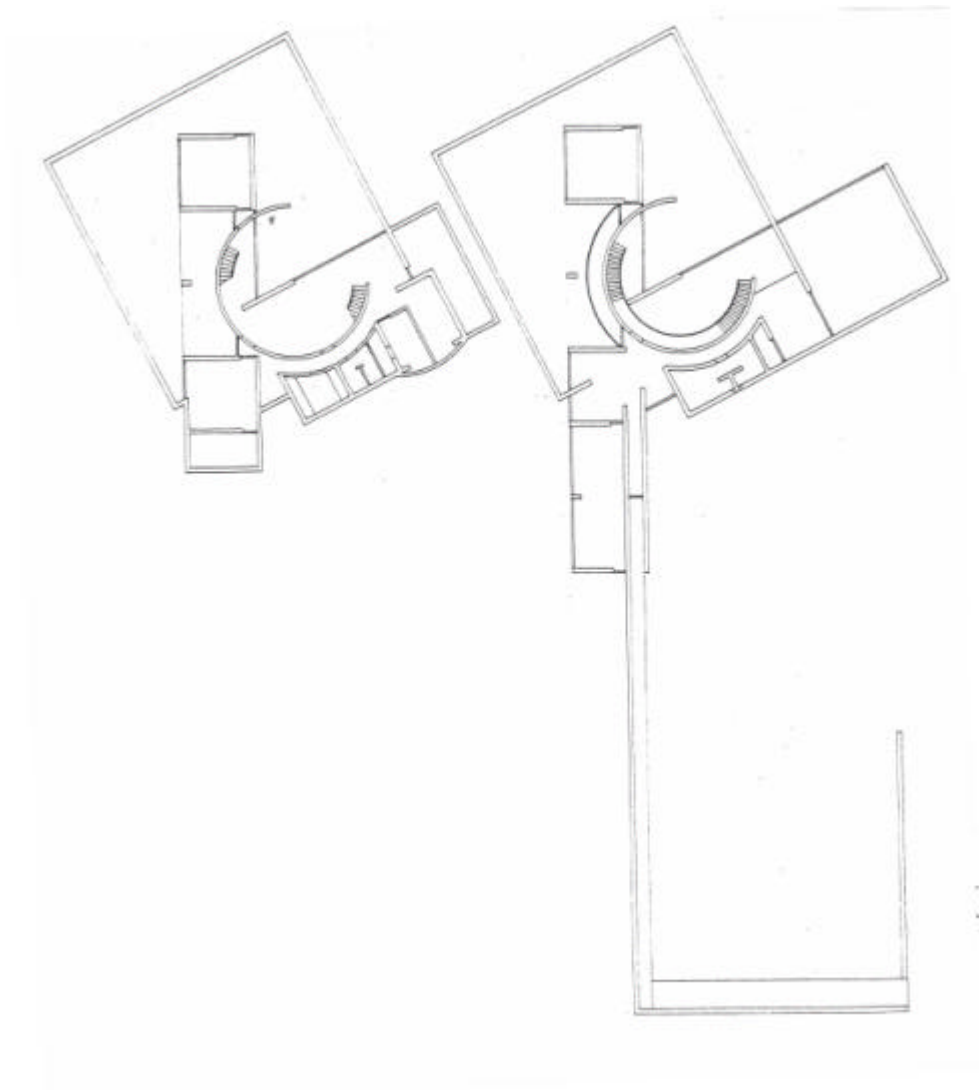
Tadao Ando, Konferenzpavillon, 1989-1993, Grundrisse Unter- und Erdgeschoß (aus: Baumeister 9, 1993, 42)
